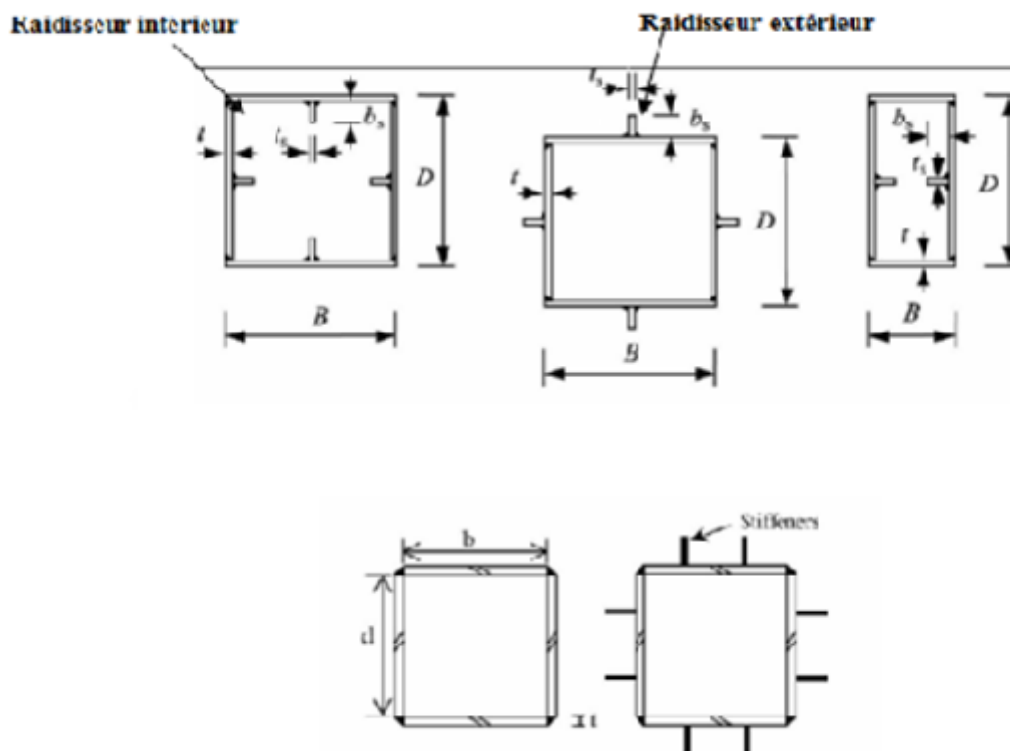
Types de poteaux mixtes avec raidisseurs longitudinaux[21].
